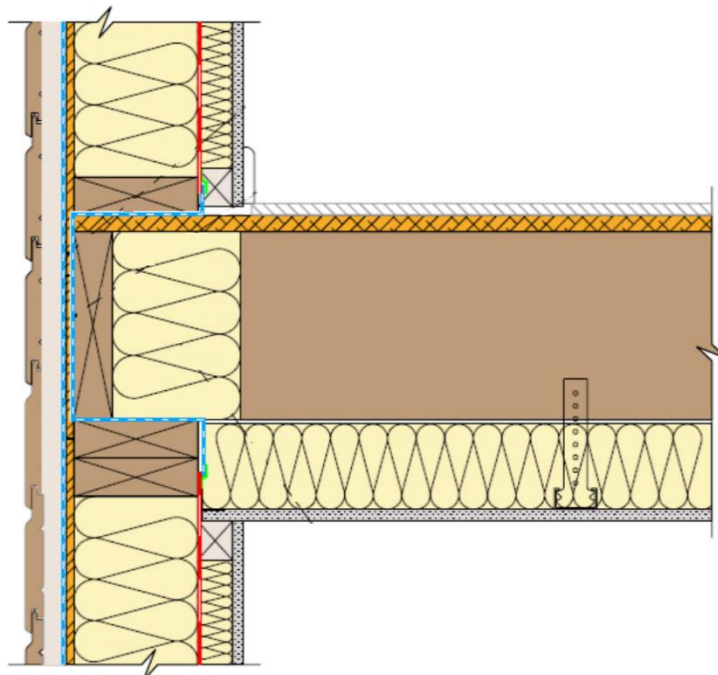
Liaison sur lisse haute d'un mur ossature bois avec complément d'isolation par l'intérieur
